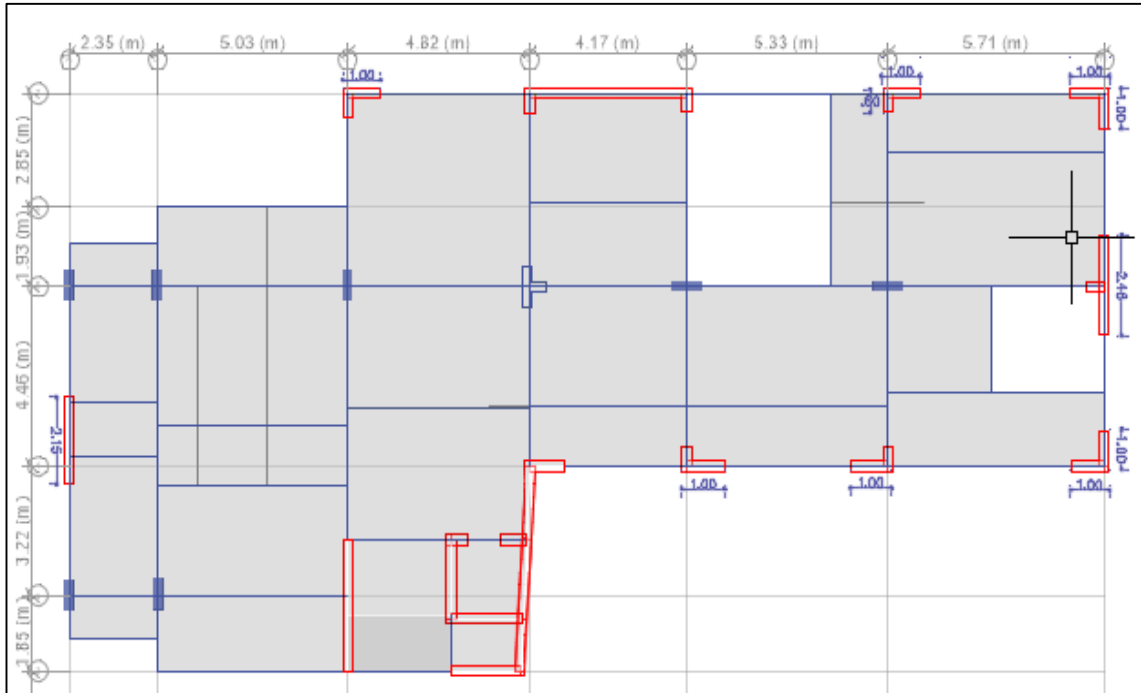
Modelo Alternativo 1. Nota: Planteado para dar una solución.
